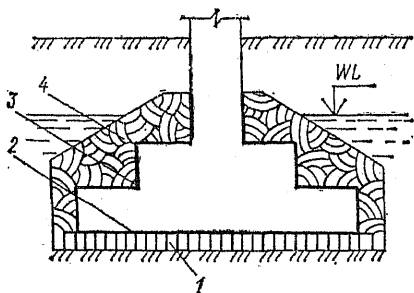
Изоляция фундамента от агрессивных подземных вод
